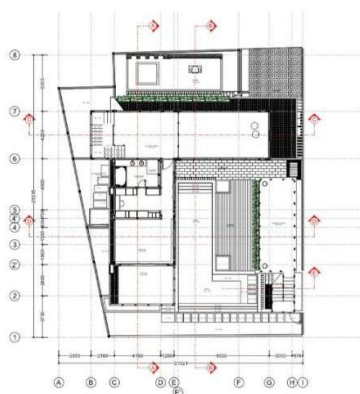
Denah Lantai 2 Proyek Urban Heaven Residence
